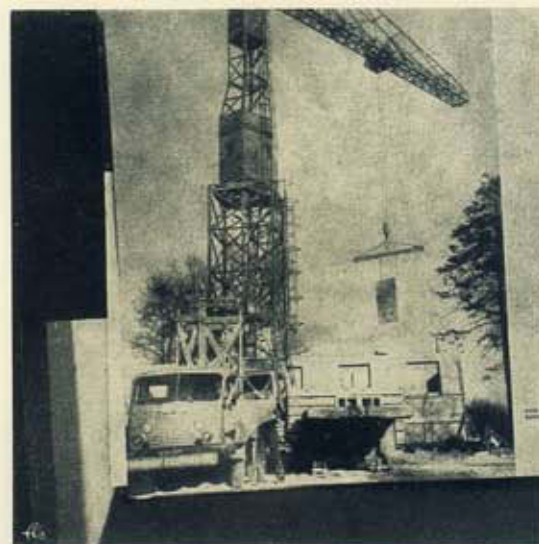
Elevação de um elemento vertical para colocação em obra.
